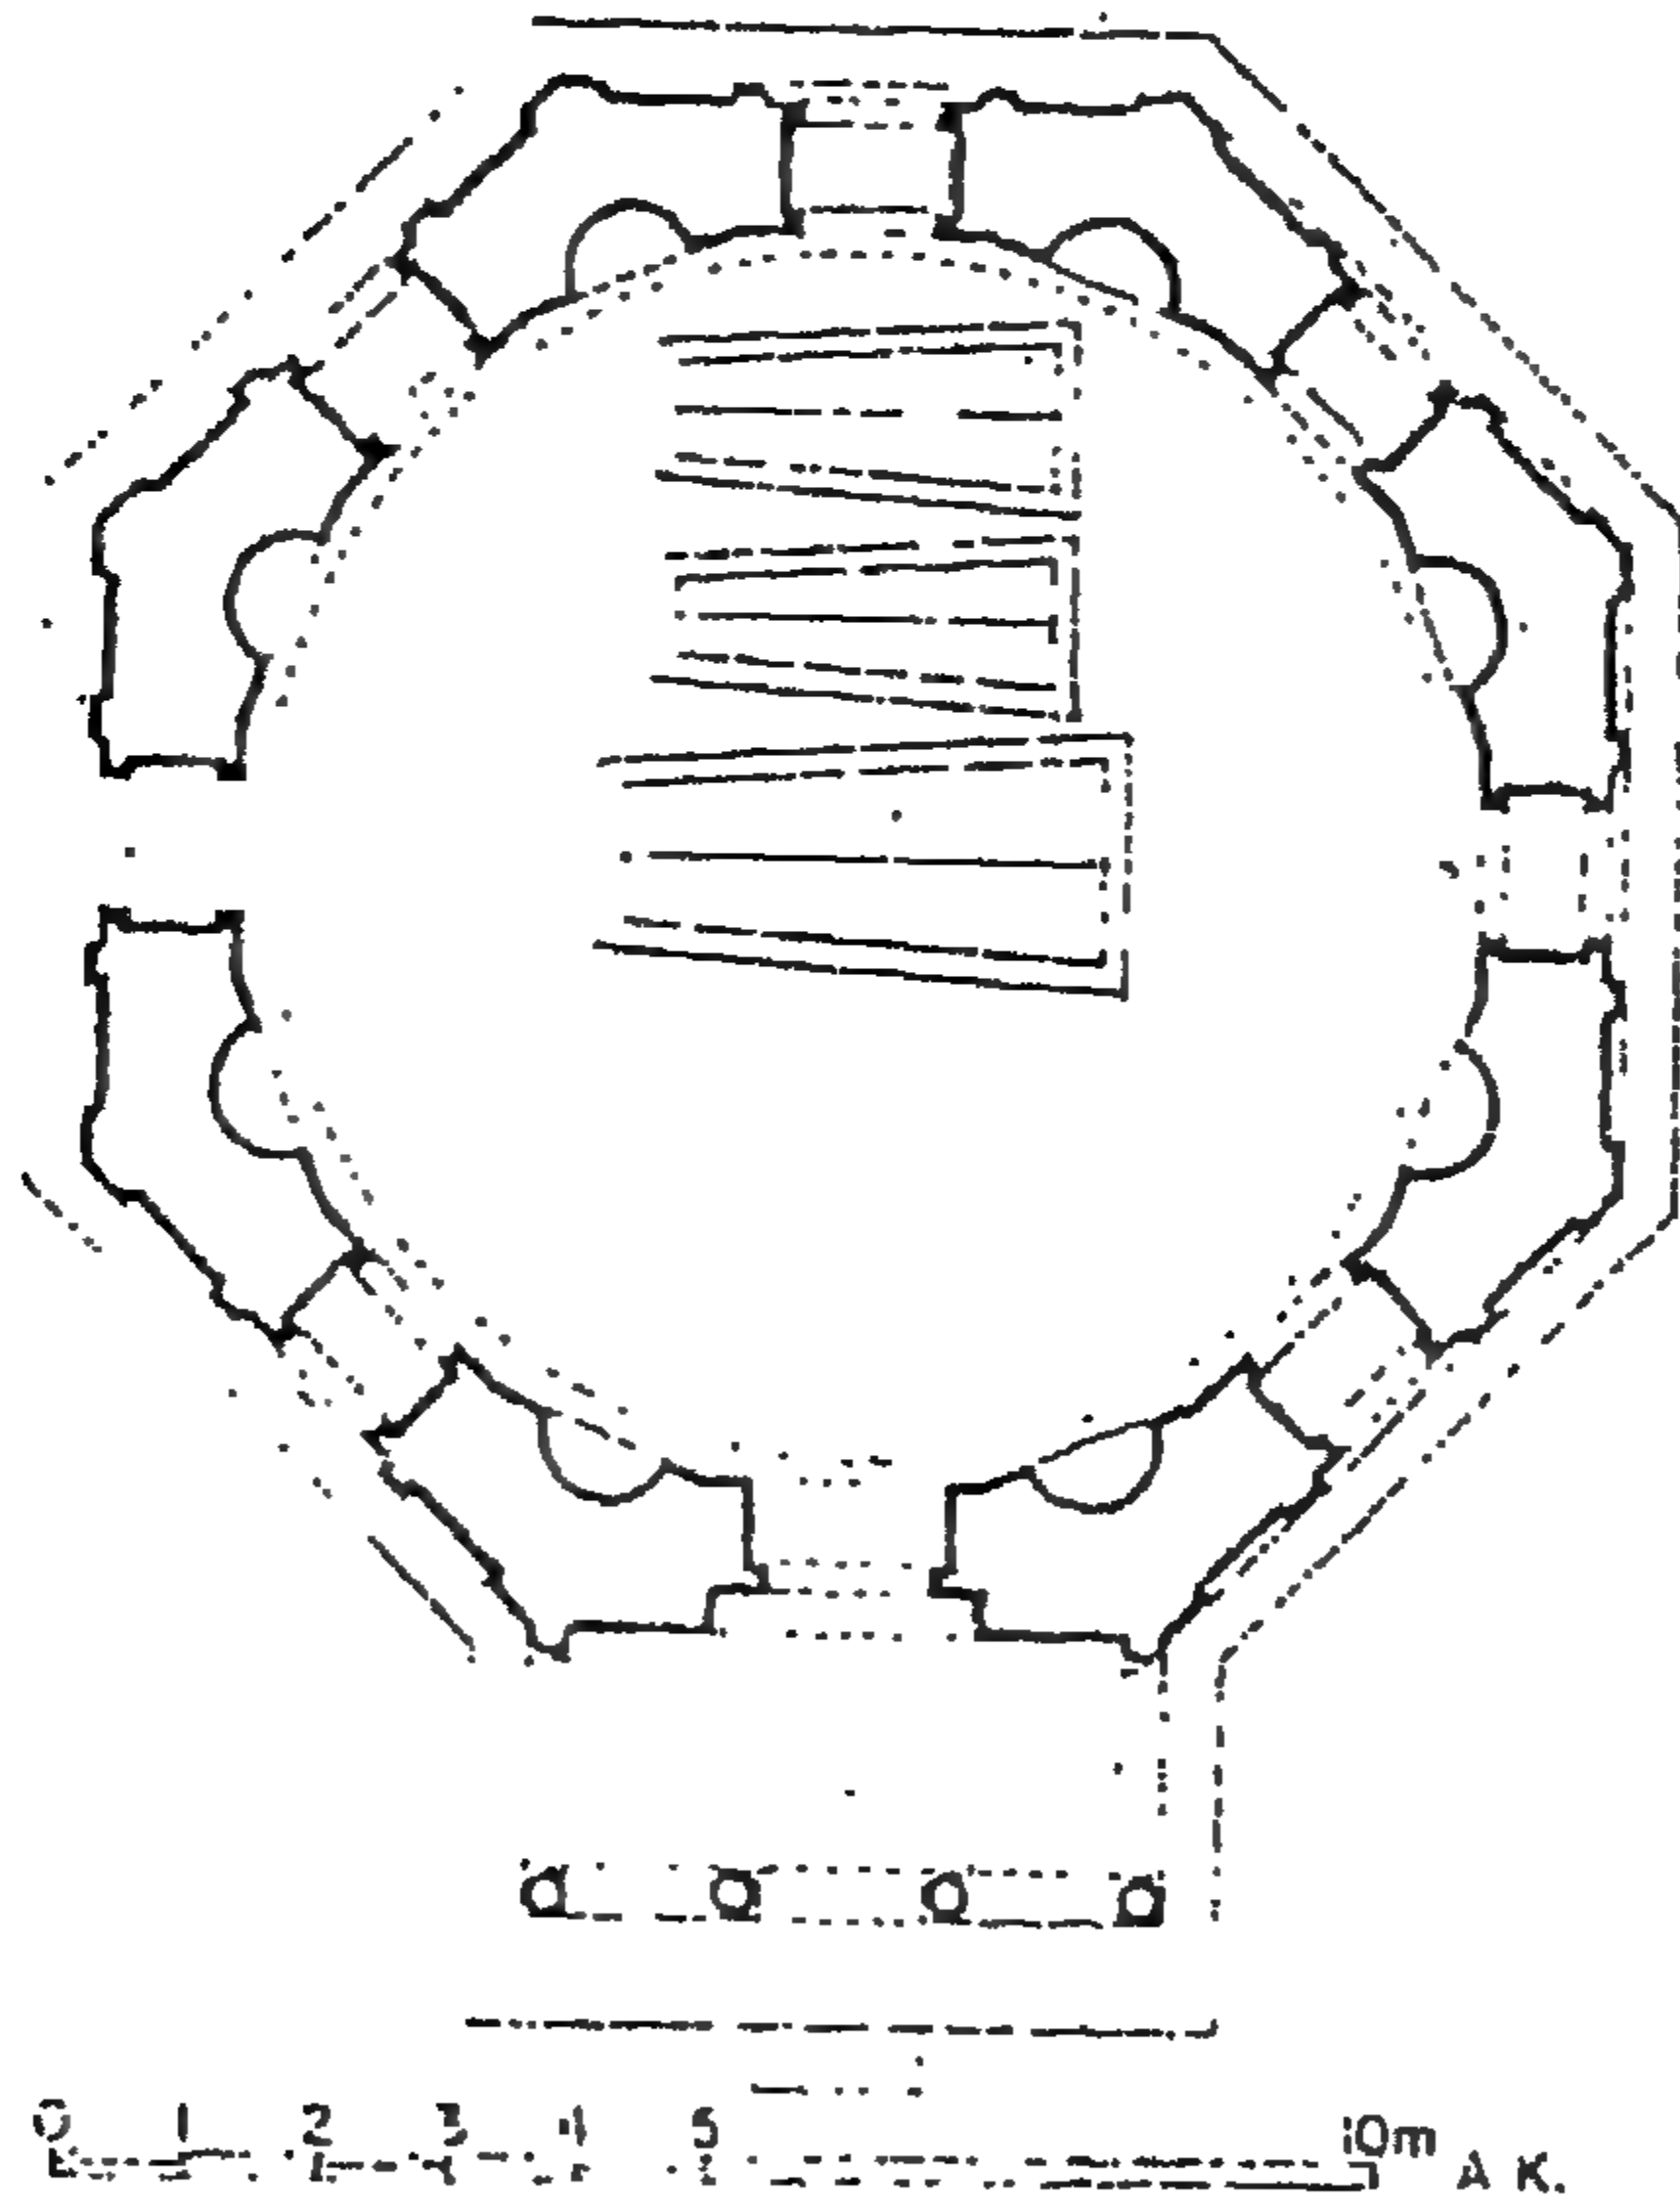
مسقط أفقى لتربة بايزيد يلدريم فى بورصة (أوبروسه) (عن : Wilde) .
